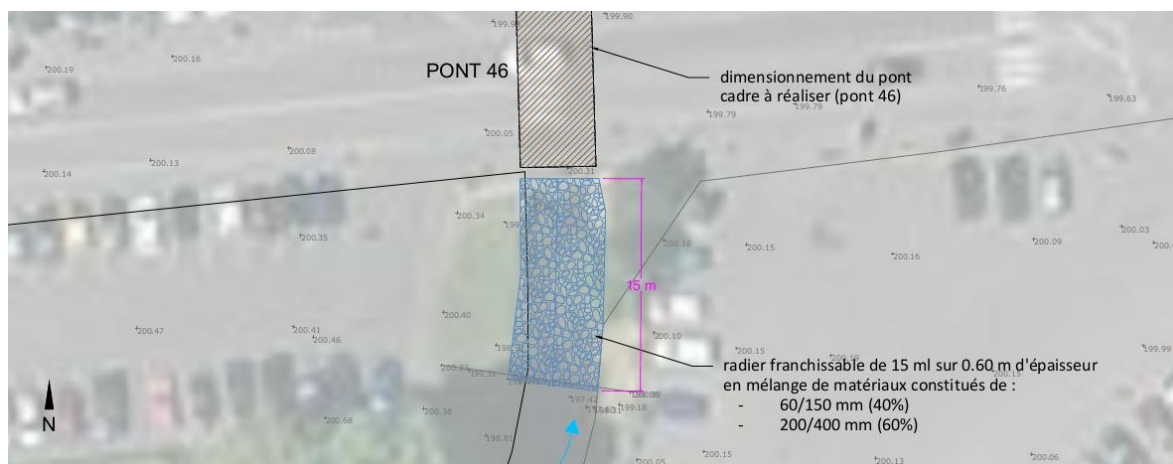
Plan masse – Création d'un radier en aval du pont 46
